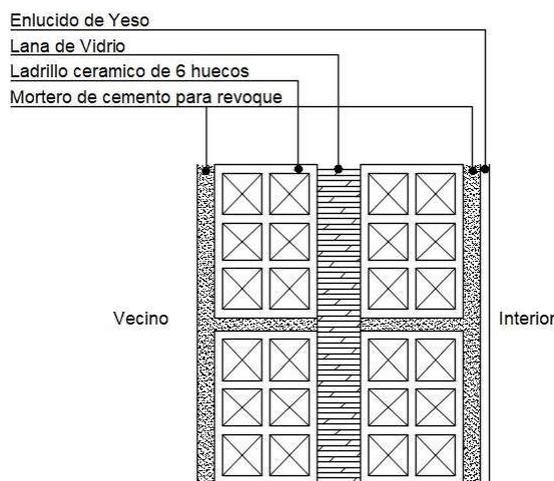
Detalle de muro colindante a vecino con aislamiento y muro doble.
